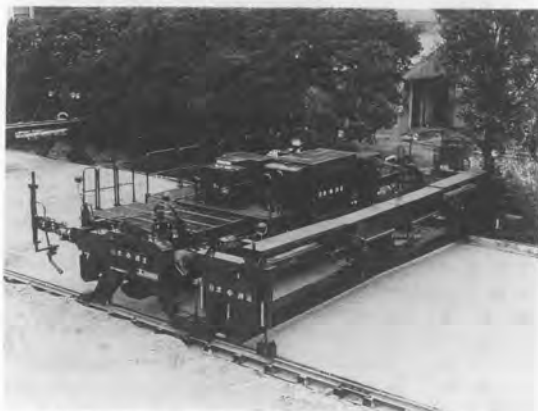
(b) 川崎 KF 85 A コンクリートフィニッシャ
